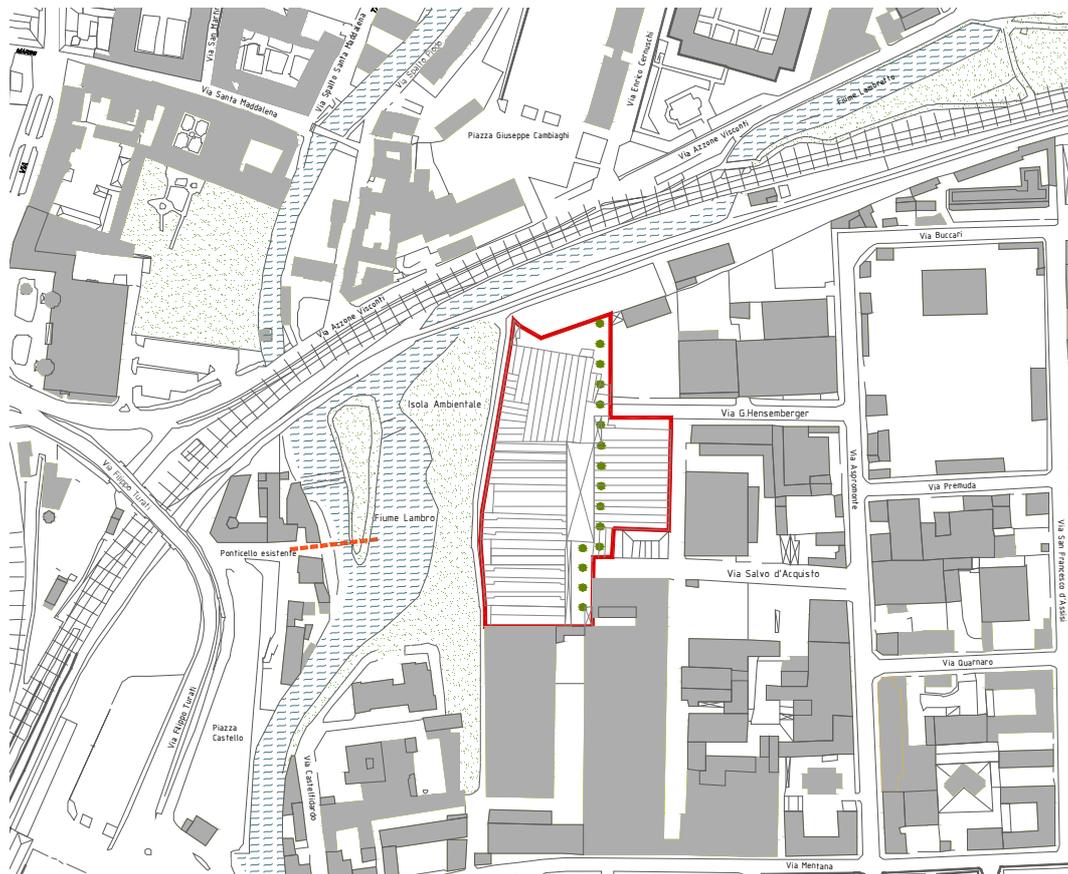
Planimetria con l'indicazione in rosso delle aree in oggetto
